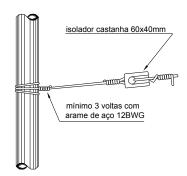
ANCORAGEM DO RAMAL DE LIGAÇÃO
